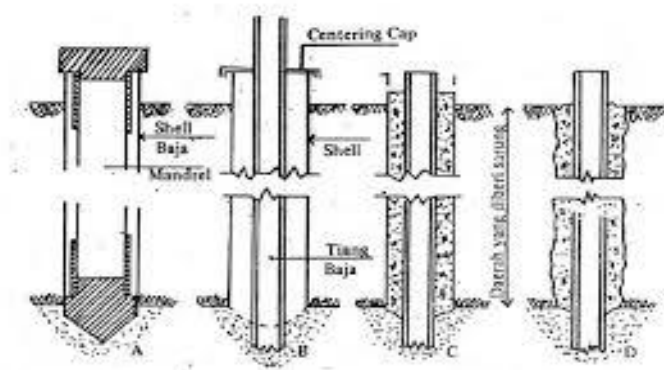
Tiang Pancang *Cast In Place Pile Frankie Pile
